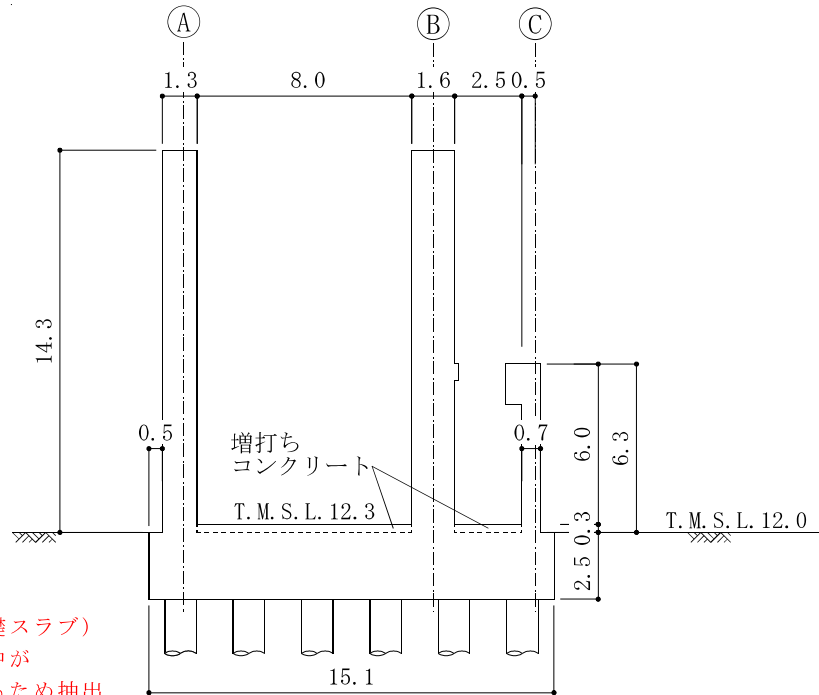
格納容器圧力逃がし装置基礎の概略平面図
